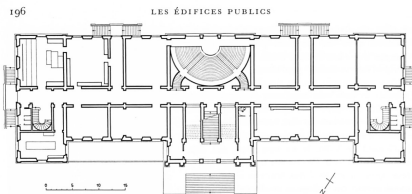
Le collège latin. Plan du rez-de-chaussée. Echelle 1:600. Page 198.
